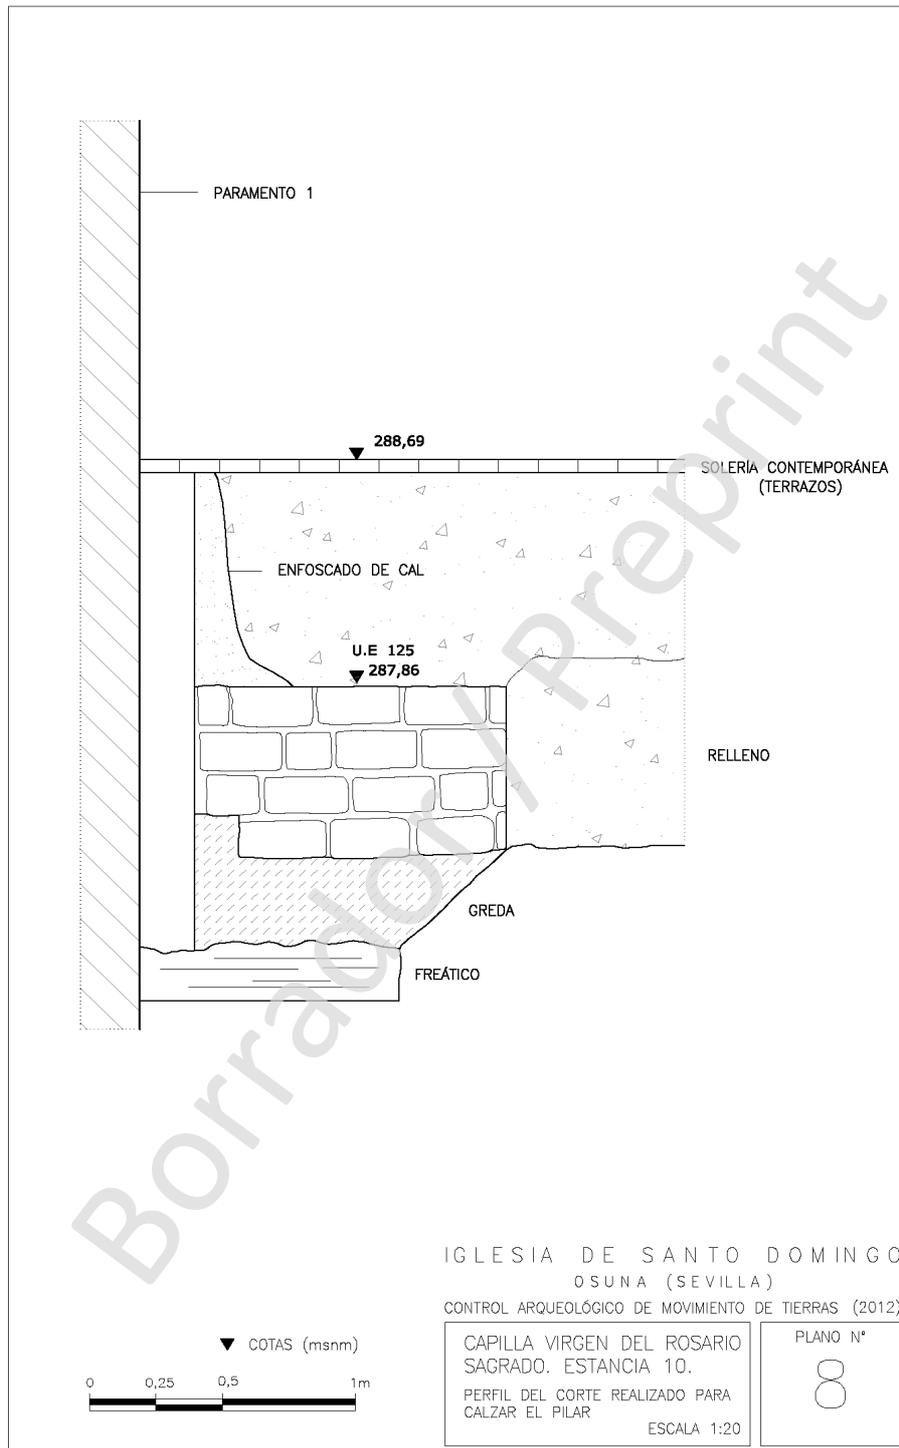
Perfil ejecutado con motivo del recalce del pilar norte de la Estancia 10
